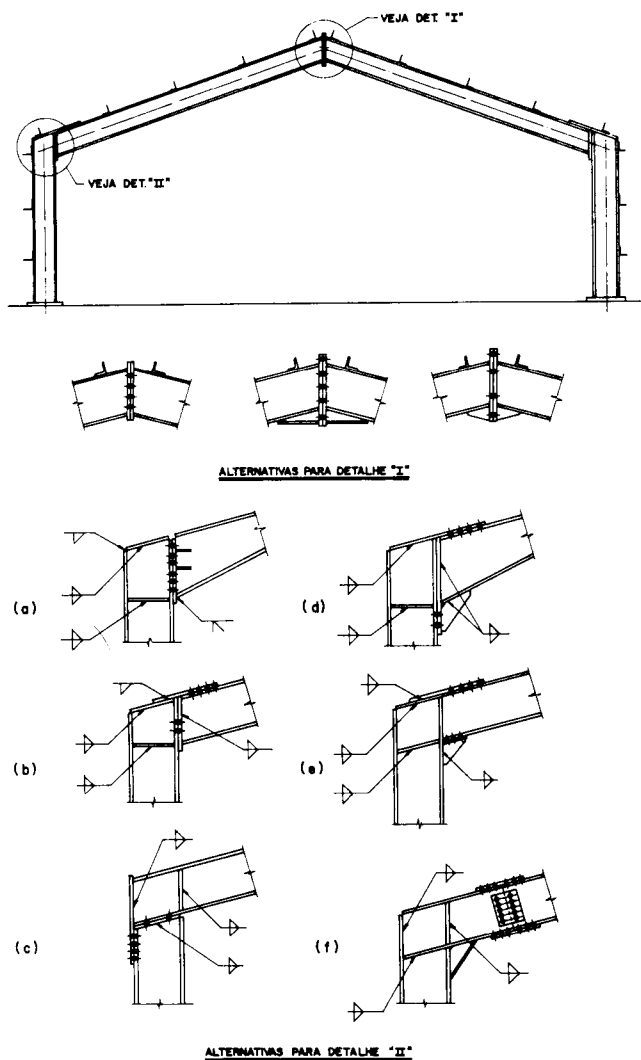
Alternativas de ligação viga-viga e viga-coluna
